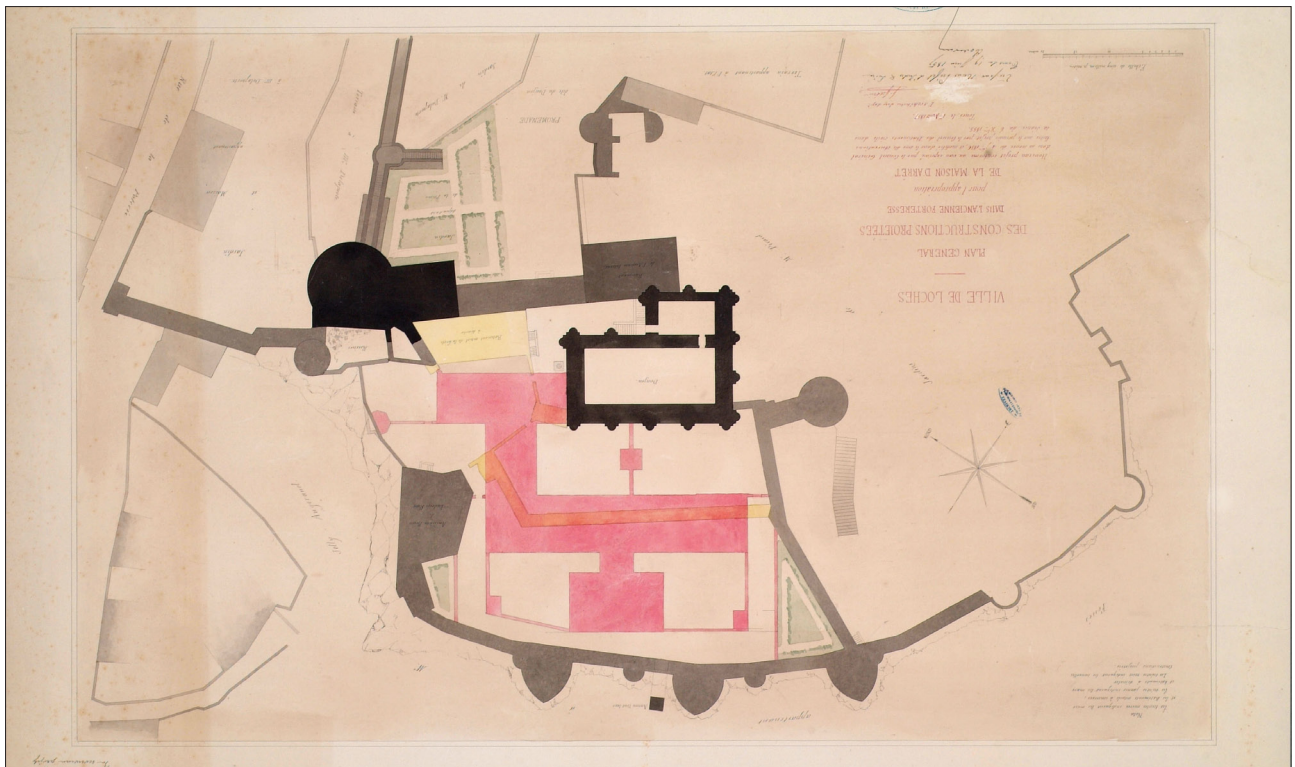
« Plan général des constructions projetées dans l'ancienne forteresse pour l'appropriation de la maison d'arrêt » par Guérin, 1857 (ADIL IV/31.3.4)
